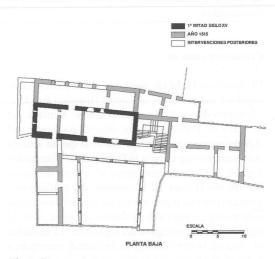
Planta baja. Etapas constructivas (López Bernal 2012)
